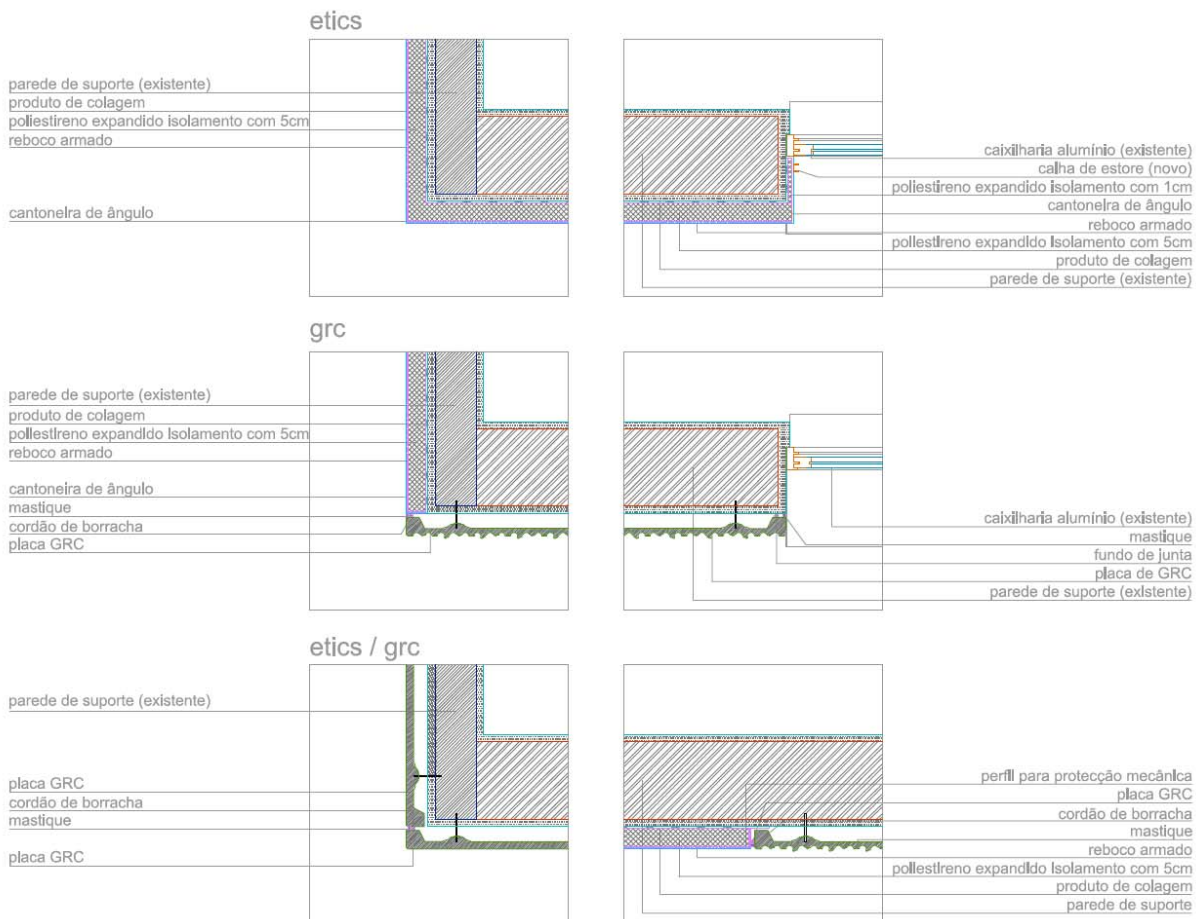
Corte construtivo horizontal. Intervenção (escala 1/20).
